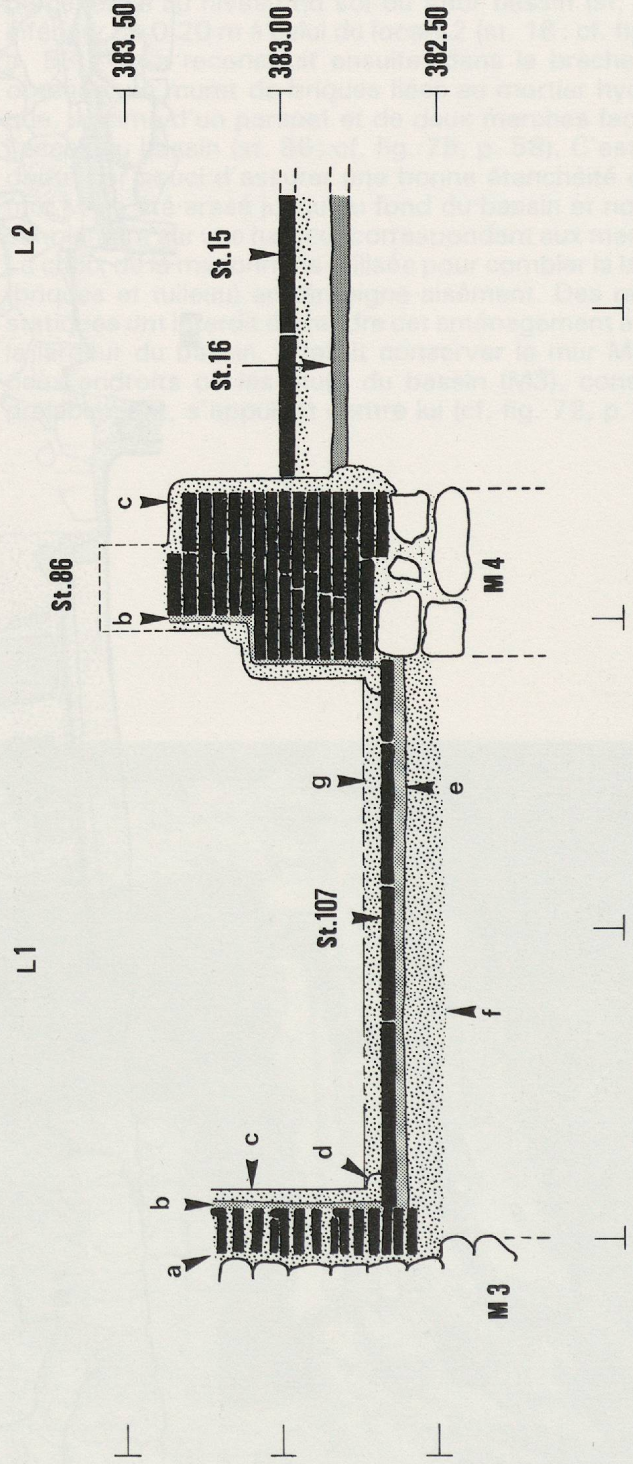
Bât. ouest, local L1: coupe restituée est-ouest, vue sud. a: opus spicatum; b: mortier hydraulique, riche en tuileau; c: mortier hydraulique, pauvre en tuileau; d: solin d'étanchéité; e: comme c; f: comme b; g: chape de mortier au tuileau; st. 15: sol du local L2, état III; st. 16: sol du local L2, état II; st. 86: seuil; st. 107: carreaux de terre cuite du sol du bassin.
